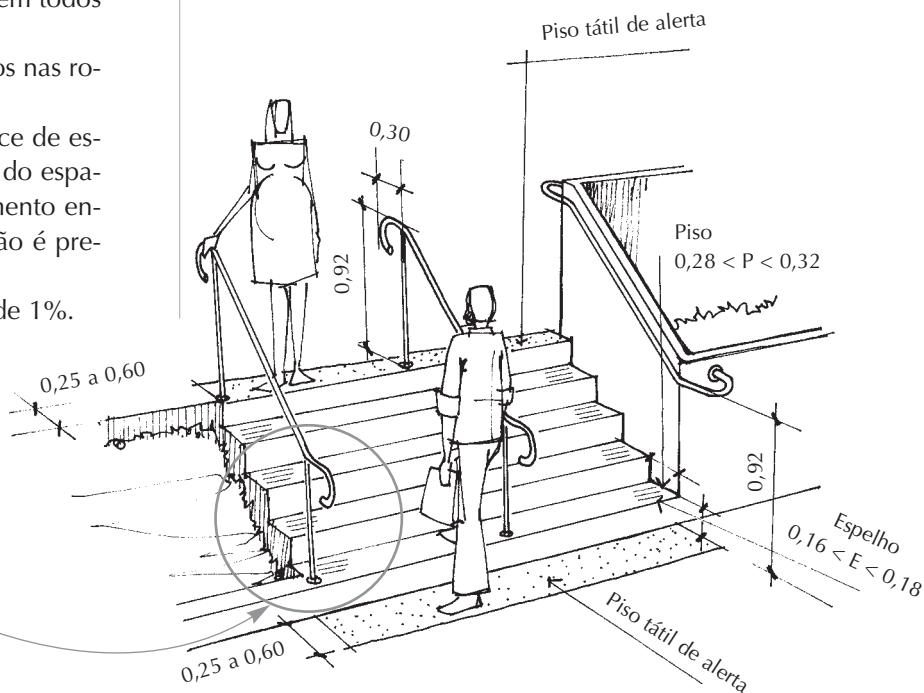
Medidas recomendadas para as escadas (dimensões em metros)
